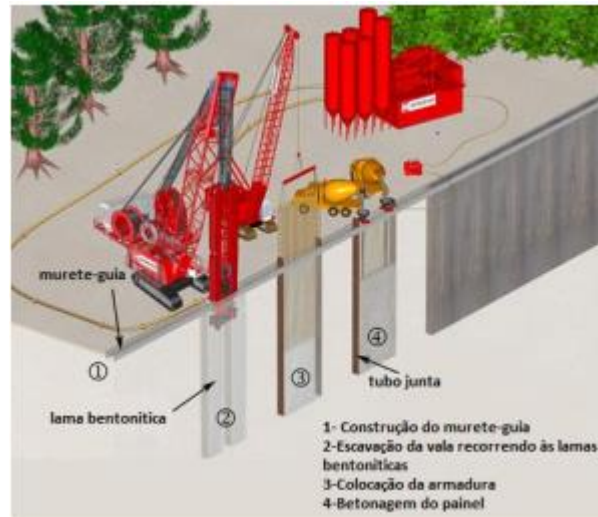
Processo de Instalação de Paredes Moldadas [15].
